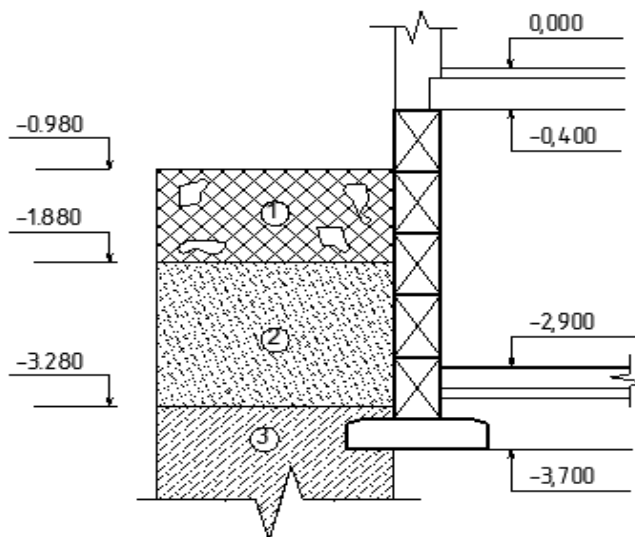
Положення фундаменту мілкового закладання у ґрунті
